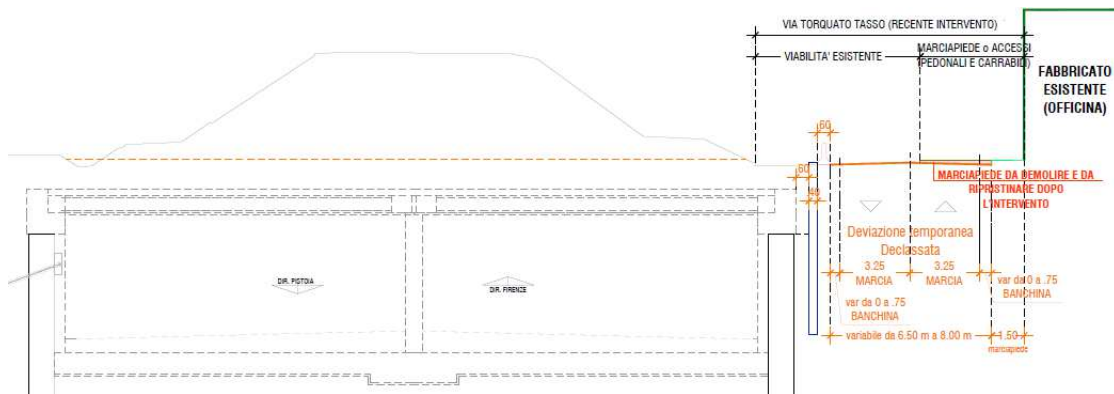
Sezione tipo deviazione provvisoria fase 2
